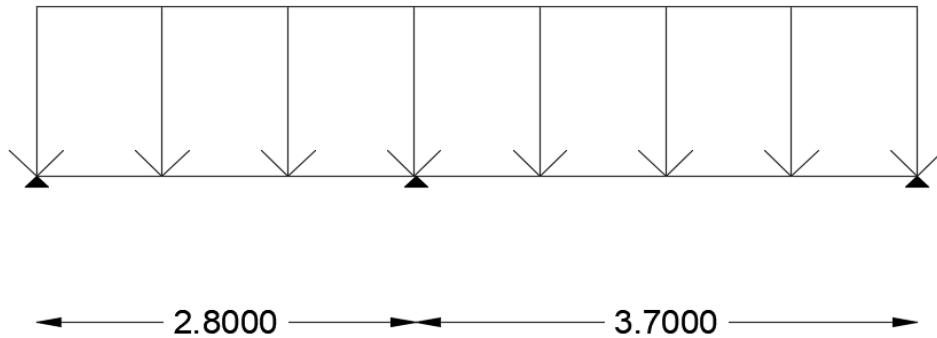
Schéma statique de la poutrelle avec combinaison a l'ELU.
